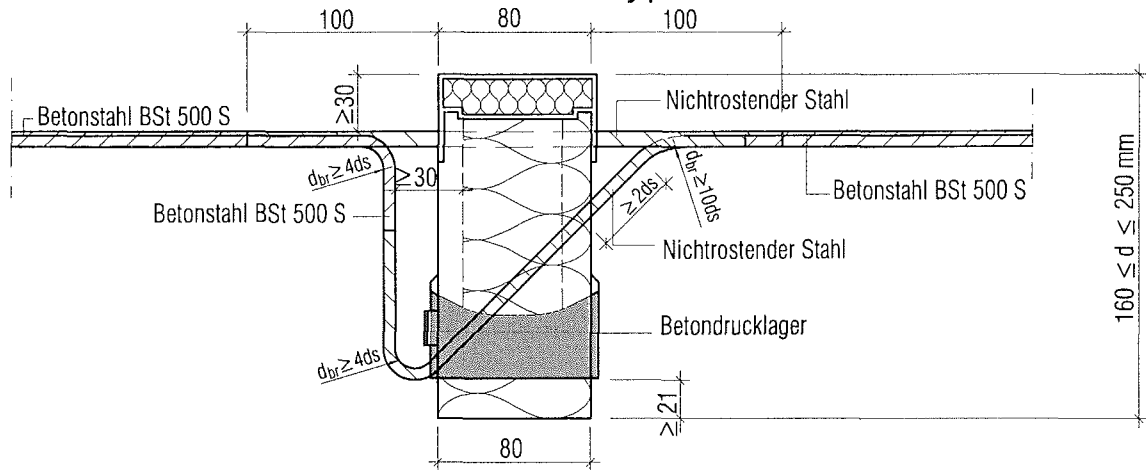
Schöck Isokorb Typ K¹⁾ mit Druck- Querkraft Kombination und integrierter Aufhängebewehrung
